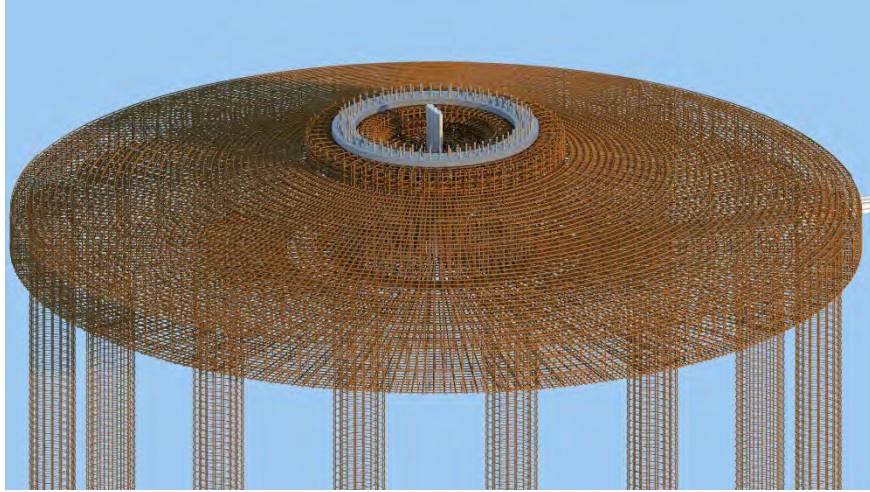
Schema tridimensionale di fondazione – Plinto su pali – tipico armatura
